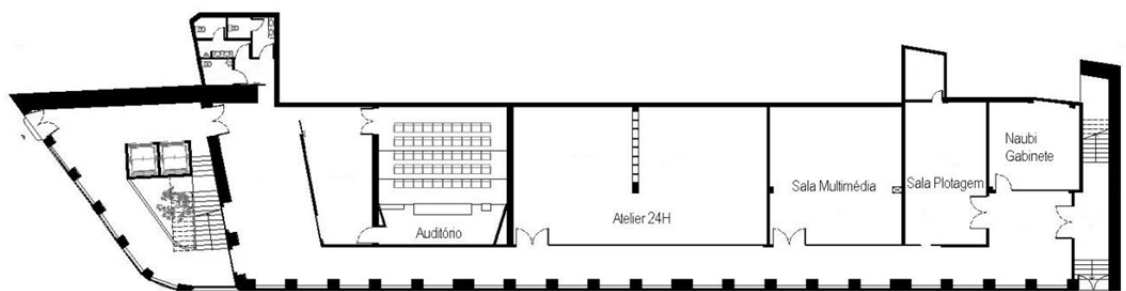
Planta do Projecto de Reabilitação, Piso 1
